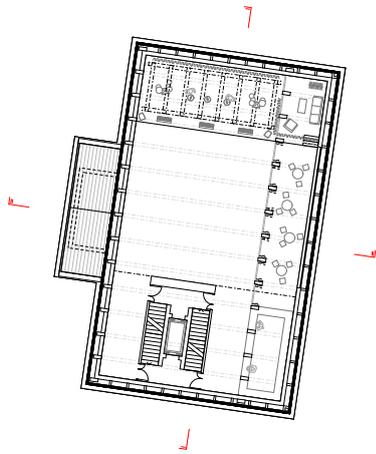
Grundriss 2. Obergeschoss Sommercasino 1:600
